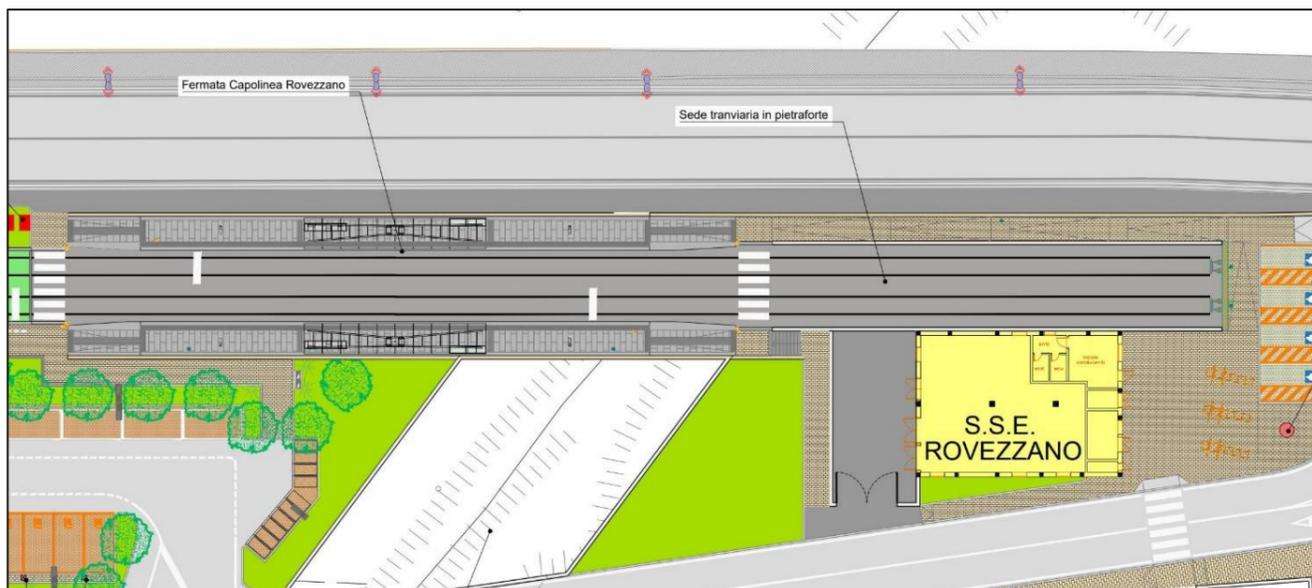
Planimetria di progetto dell'area del capolinea di Rovezzano
